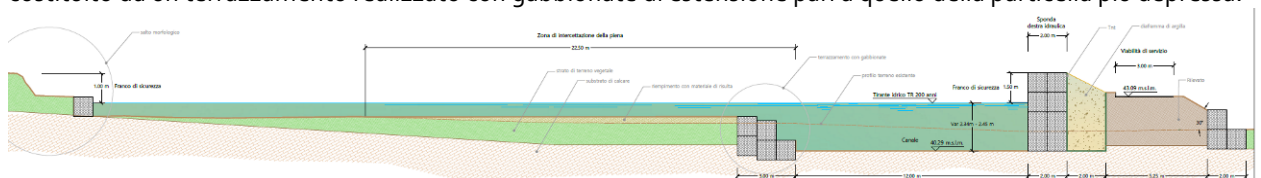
Sezione tipologica 6 (Intercettazione reticolo di esondazione della lama dell'Aglio)
